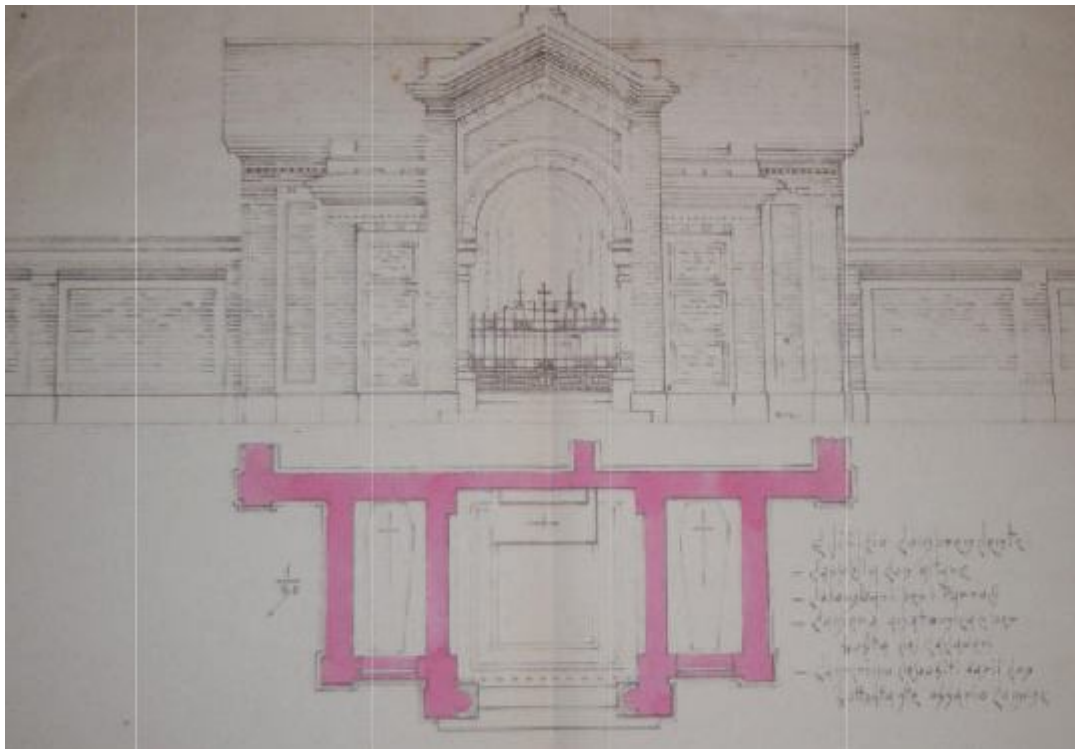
Disegno esecutivo cimitero "Nuovo" Colombari dei Sacerdoti – prospetto e pianta.
